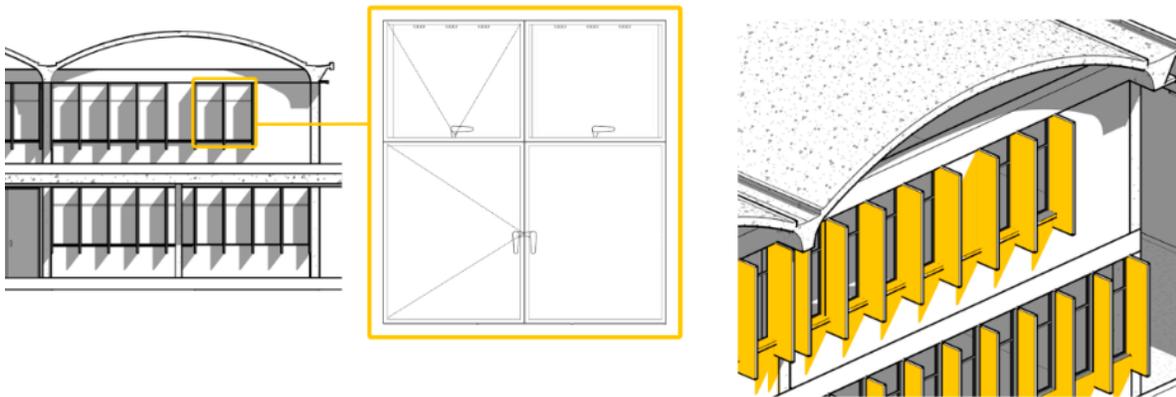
Fachada Oeste. Arquitectura moderna Geometría simple.
